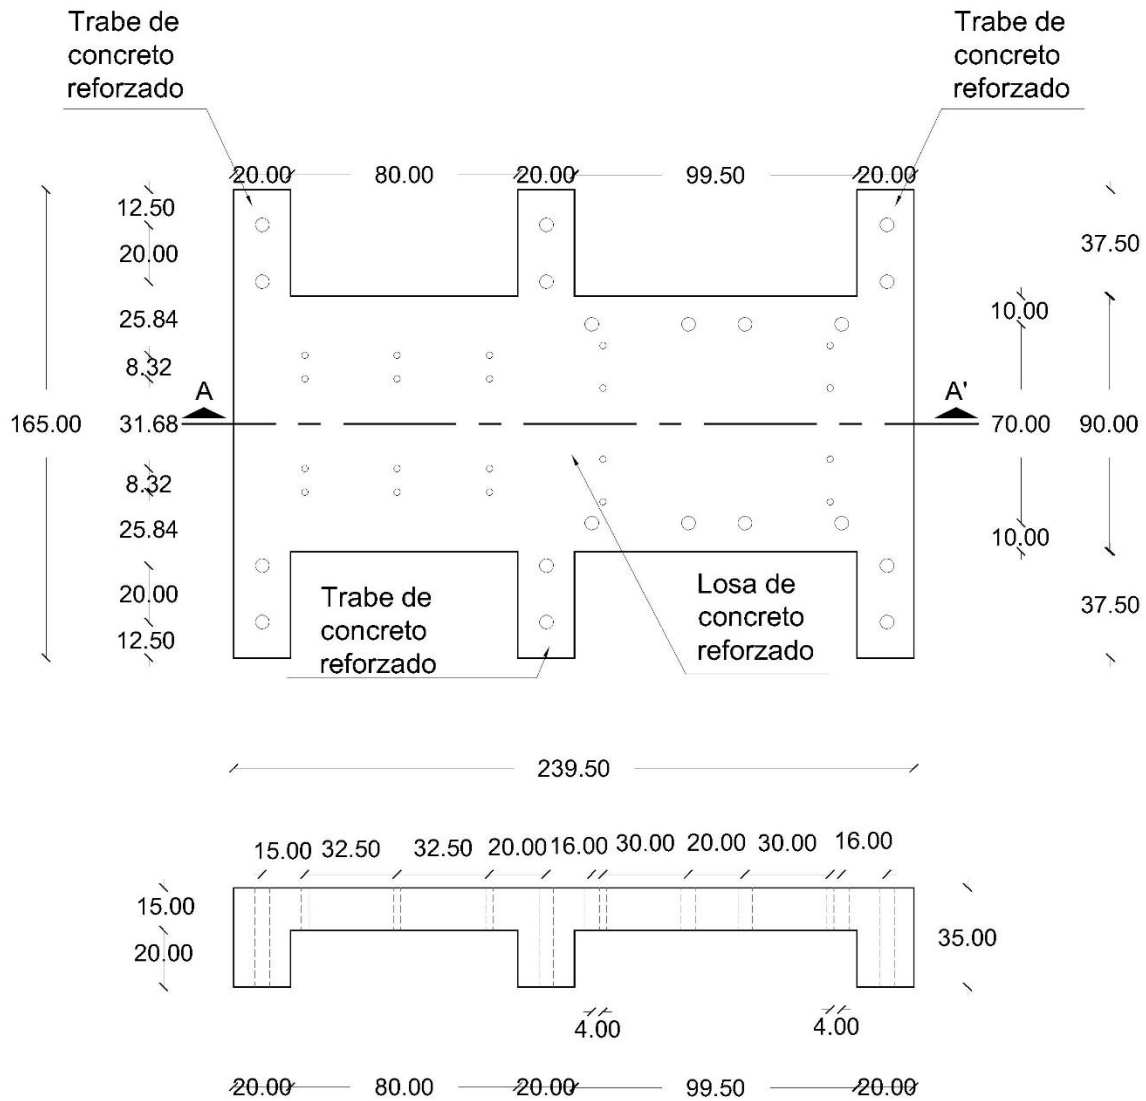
Dimensiones de la losa de reacción móvil (vista en planta y corte A-A').
